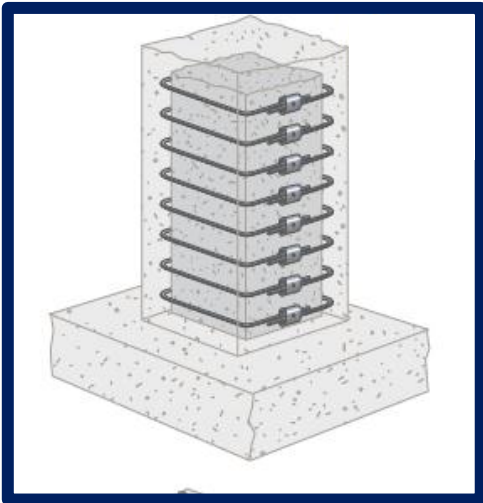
Conectores utilizados para reparar o extender columnas existentes.
